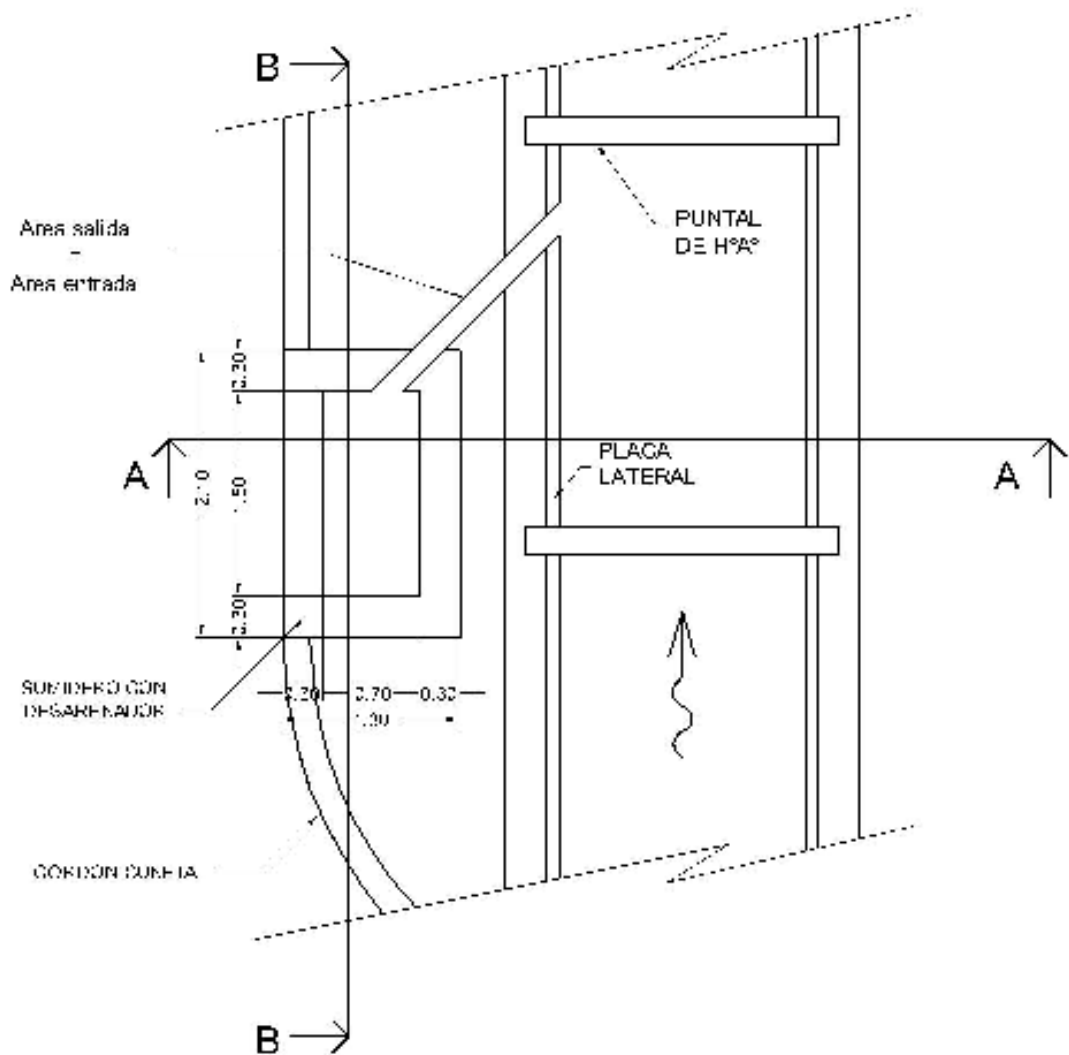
Vista en planta de la intersección entre el canal y el sumidero
